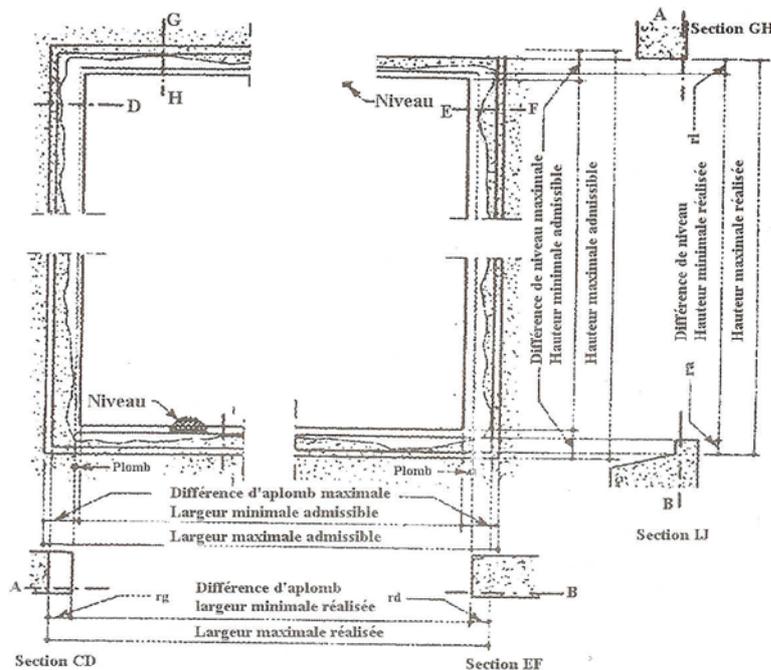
Coupe et section verticale et section horizontale Dimension réalisées par rapport aux dimensions admissibles d'une baie
